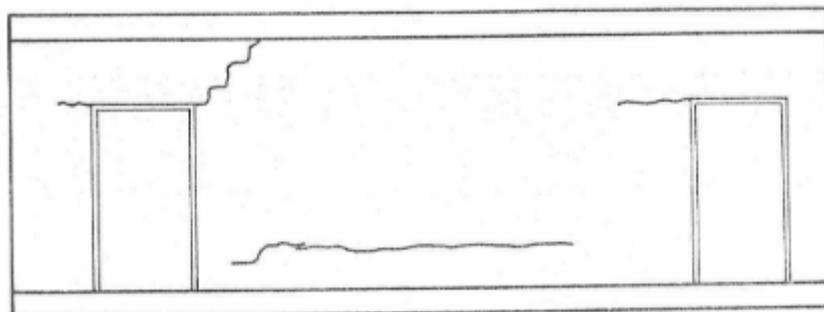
Fissuração na base da parede causada por deformação excessiva semelhante nos componentes superior e inferior.
